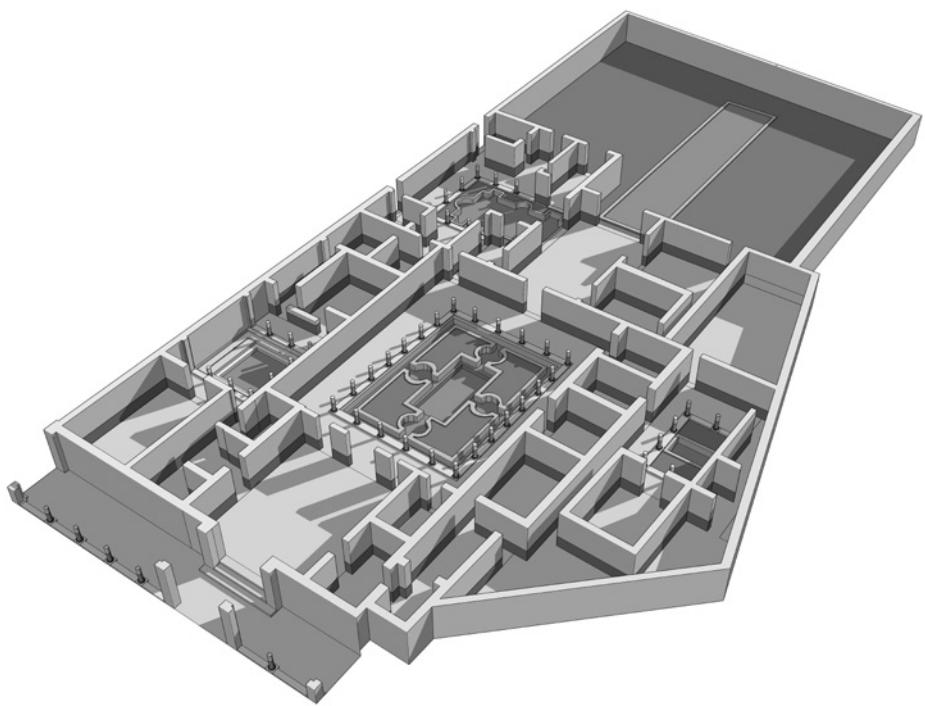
Restituição da planimetria da ‘Casa do Cantaber’ em Conimbriga.
